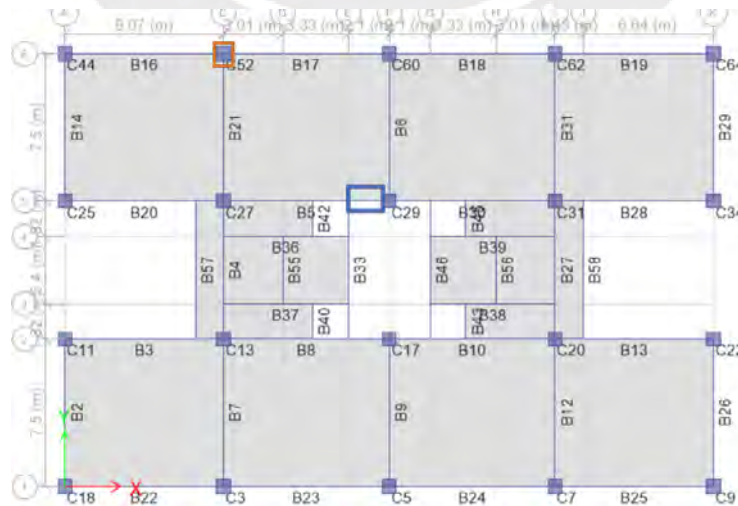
Ubicación de la rótula más girada para la viga (piso 3) y columna (piso 1) en dirección X-X.
